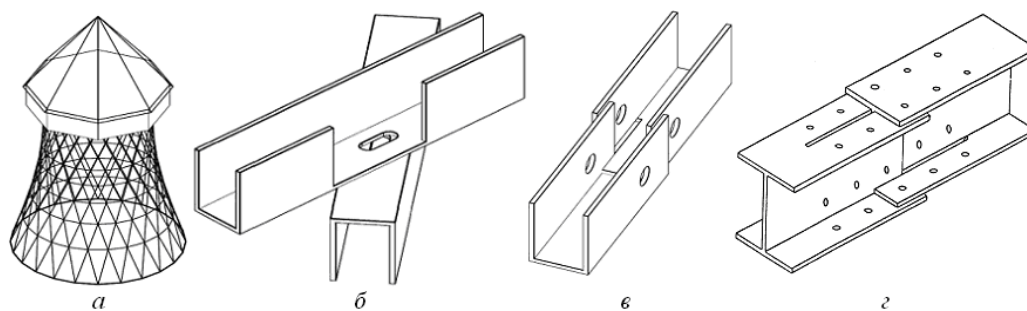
Схемы гиперboloидной конструкции (а), болтового узла пересекающихся стержней (б) и болтового стыка стержня (в), а также его прототипа (г)
